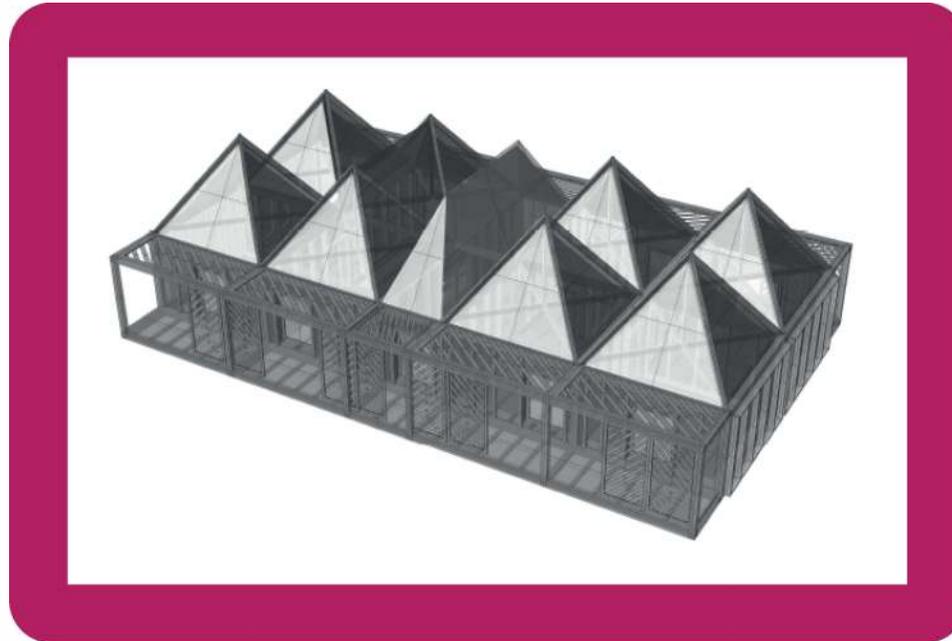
Ilustra la construcción de un modelo virtual con el Sistema para construcción ADDRH.
